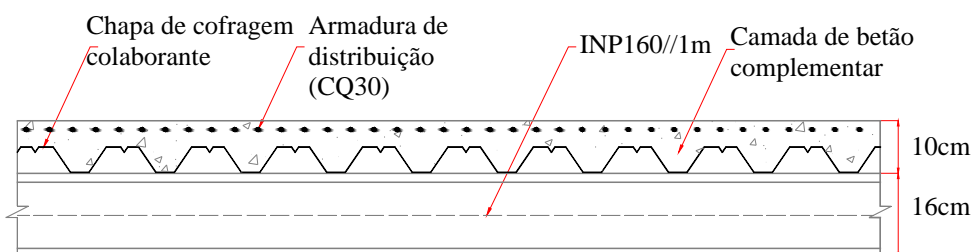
Pavimento misto de cofragem metálica colaborante sem isolante térmico (Pav10)
